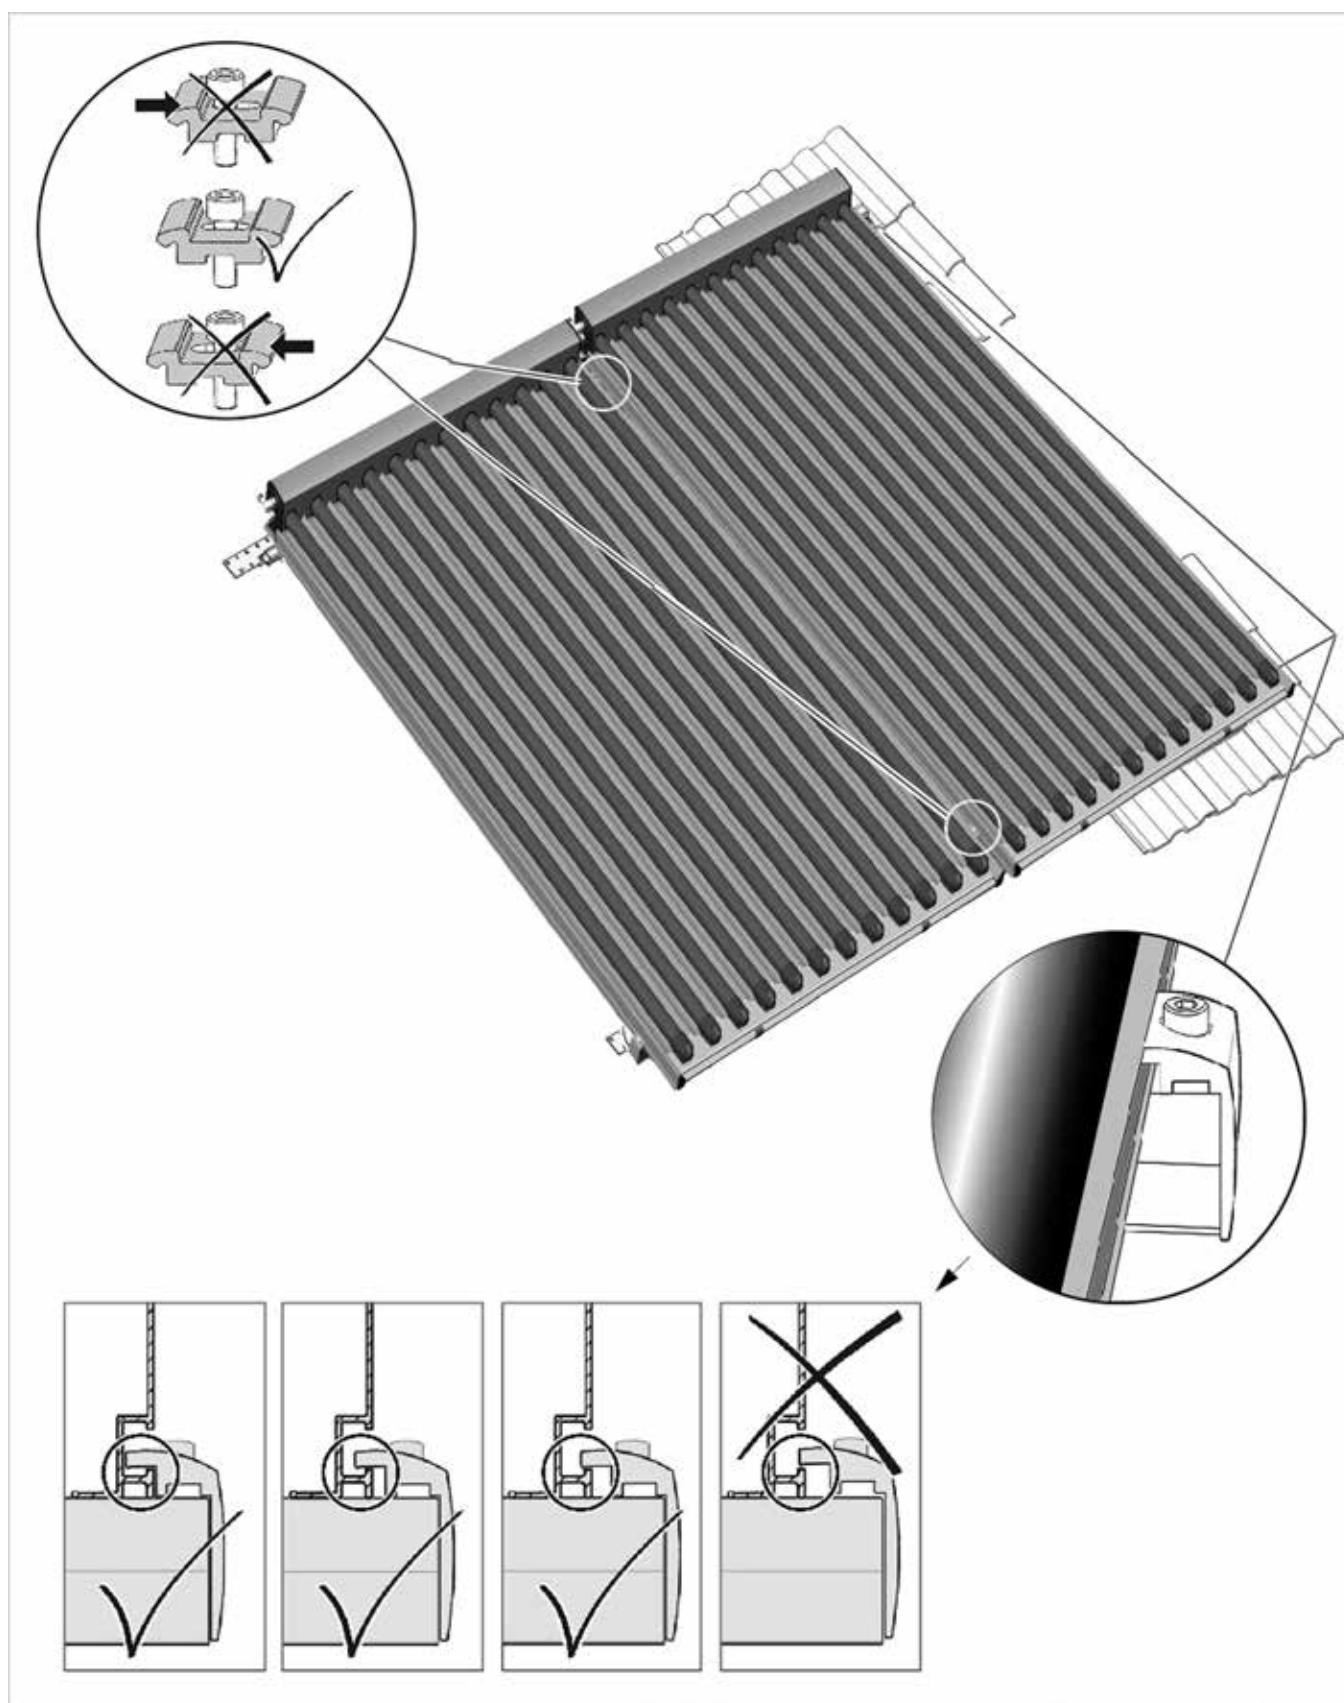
fixation de capteurs supplémentaires sur les rails de support
